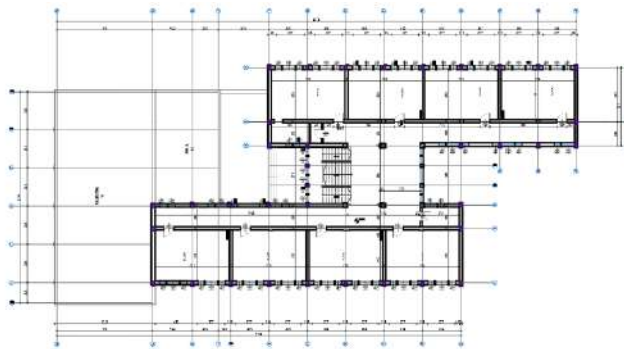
Planimetria e katit të tretë gjendja ekzistuese
